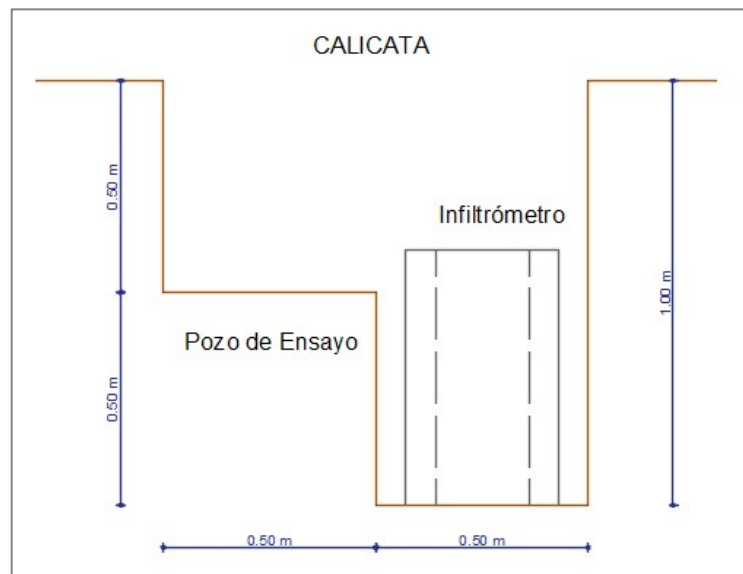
Vista en elevación de la calicata, pozo de ensayo e infiltrómetro.
